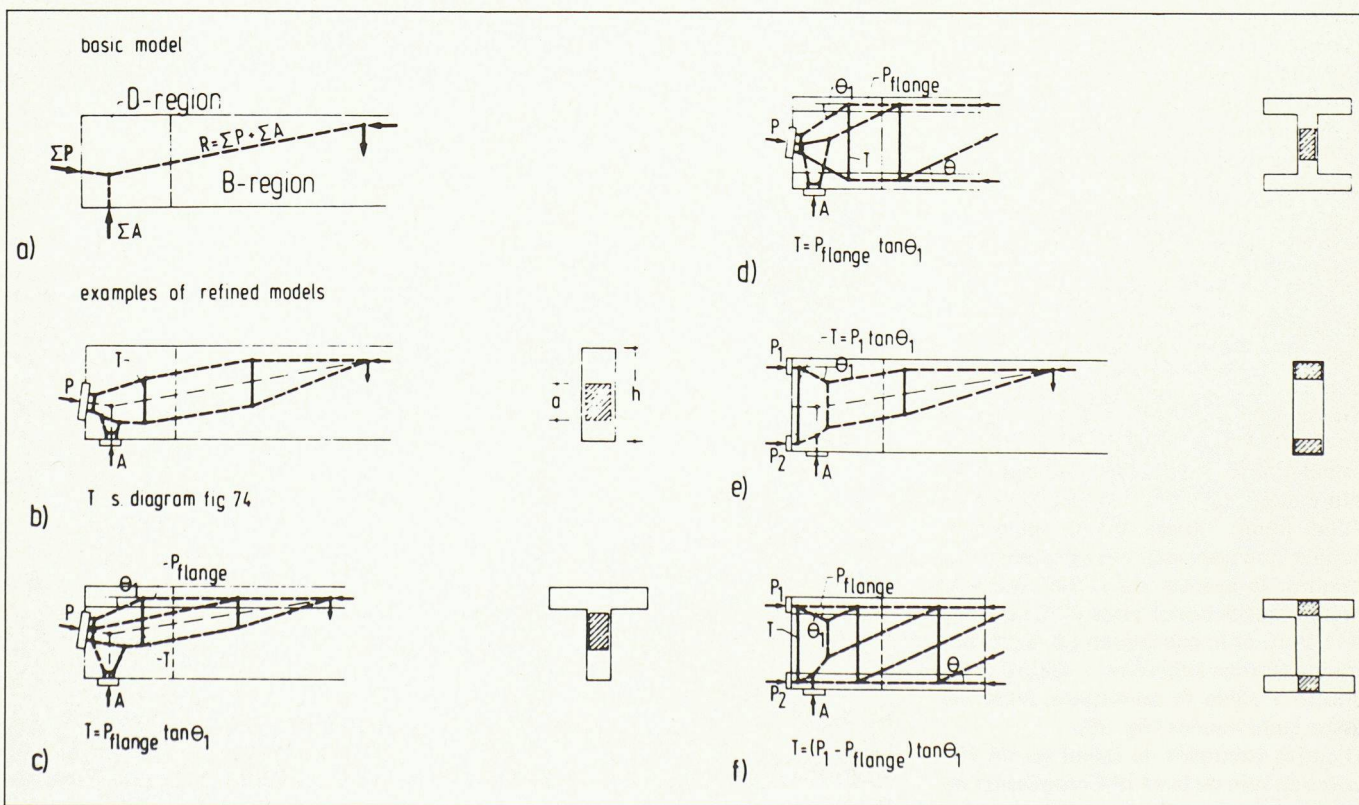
Flux des forces dans la zone d'ancrage des câbles à l'about d'une poutre.
